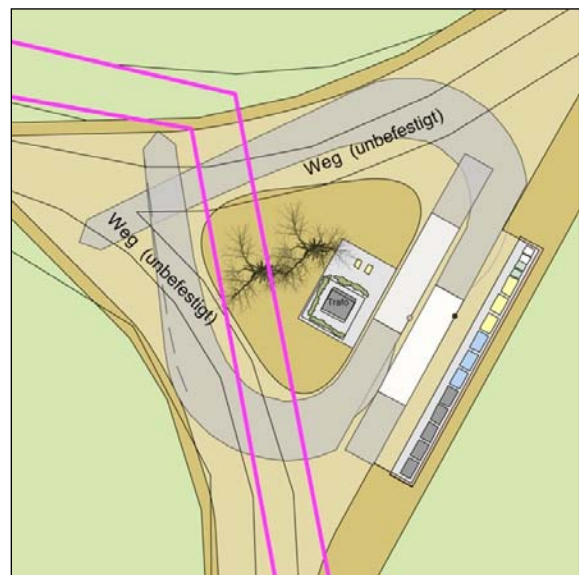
Fläche für Müll- und Wertstoffcontainer Entwurfsvariante 2 (Stand 05/2016)
